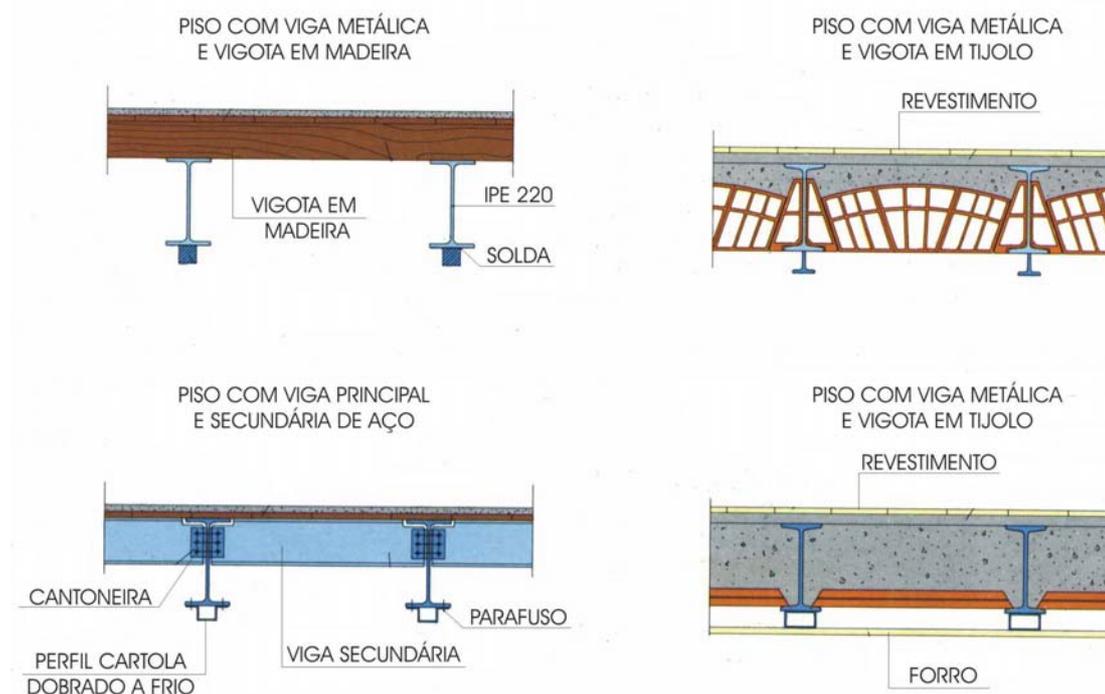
Aumento da seção da viga de aço com elementos soldados em sua face inferior.
